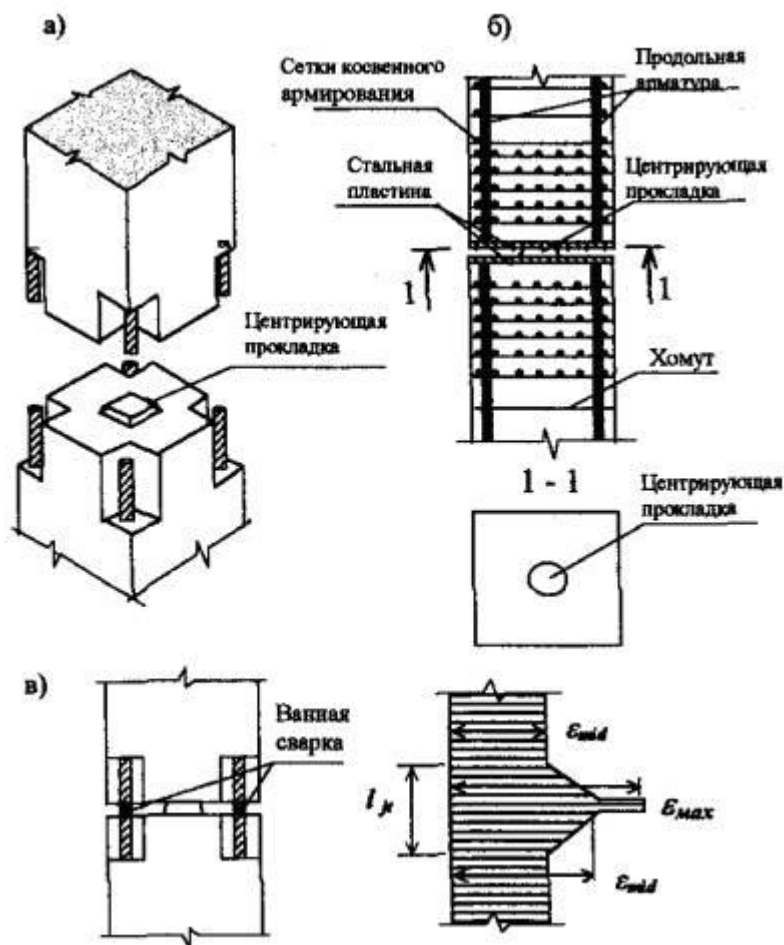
Вертикальные стыки колонн: а) жесткий, со сваркой продольной арматуры; б) шарнирный без соединений по продольной арматуре; в) стык в сборке и эпюра распределения продольных деформаций
